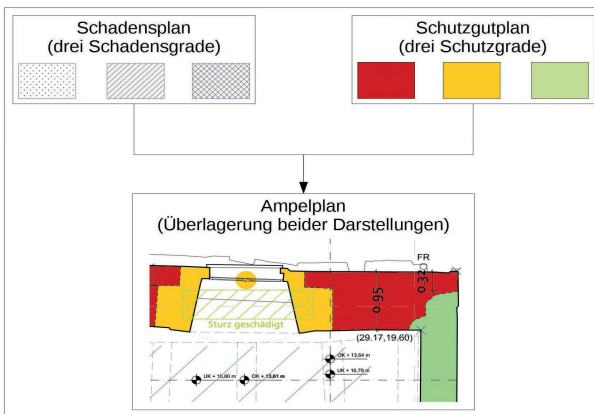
Schema zur Entwicklung des „Ampelplans“ als maßgeblicher Entwurfsgrundlage aus Schutzgutplan und Schadensplan.
